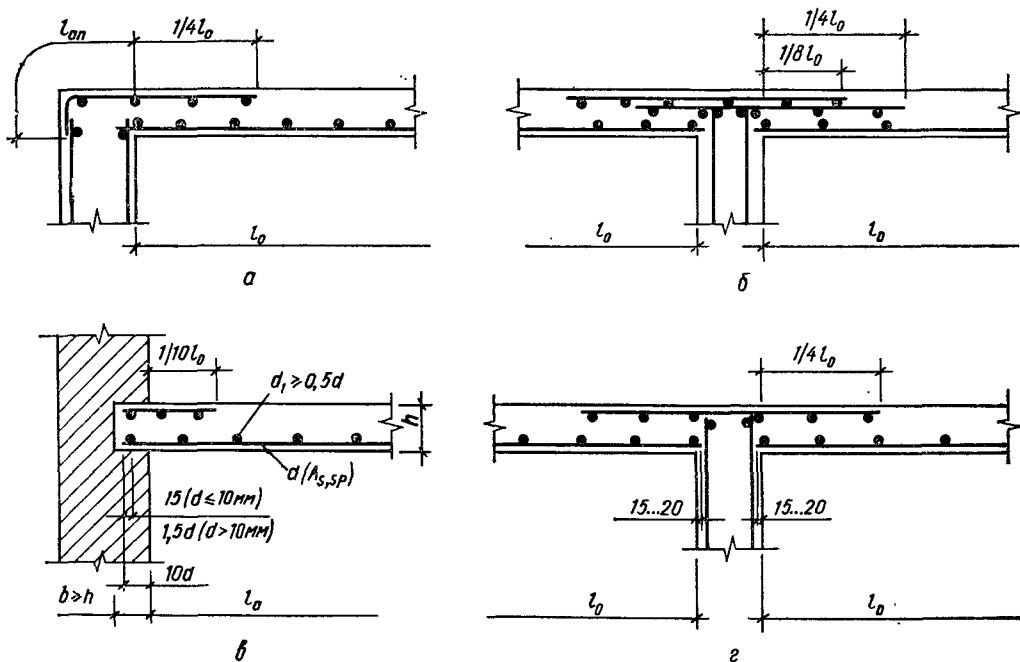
Армирование опор плит сварными сетками (разрезы в рабочем направлении):
